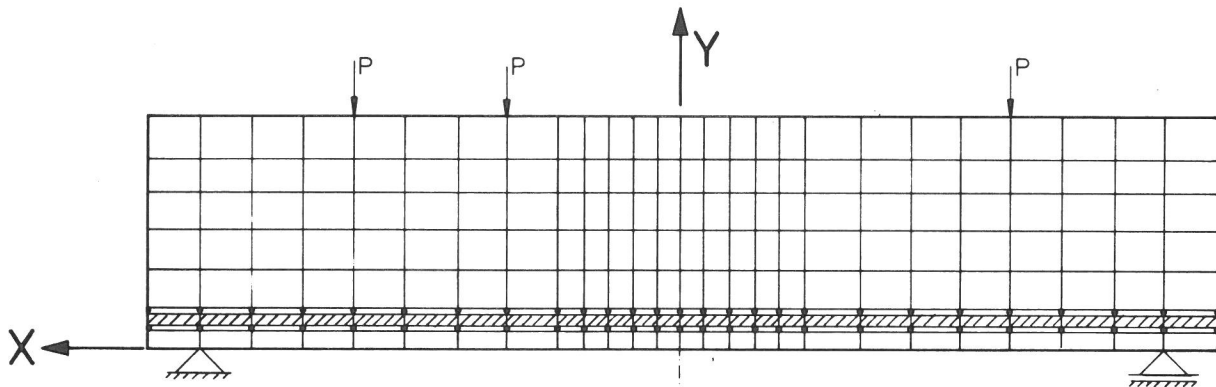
Finites Elementmodell eines querbelasteten Stahlbetonbalkens mit beliebiger Anordnung der Belastung
